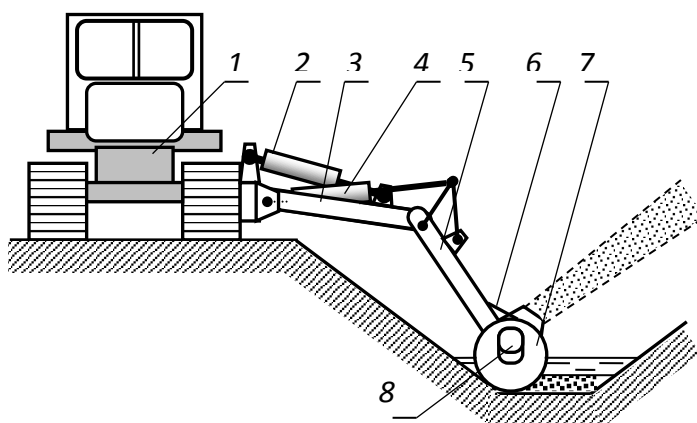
Схема работы каналоочистителя с фрезерным рабочим органом
